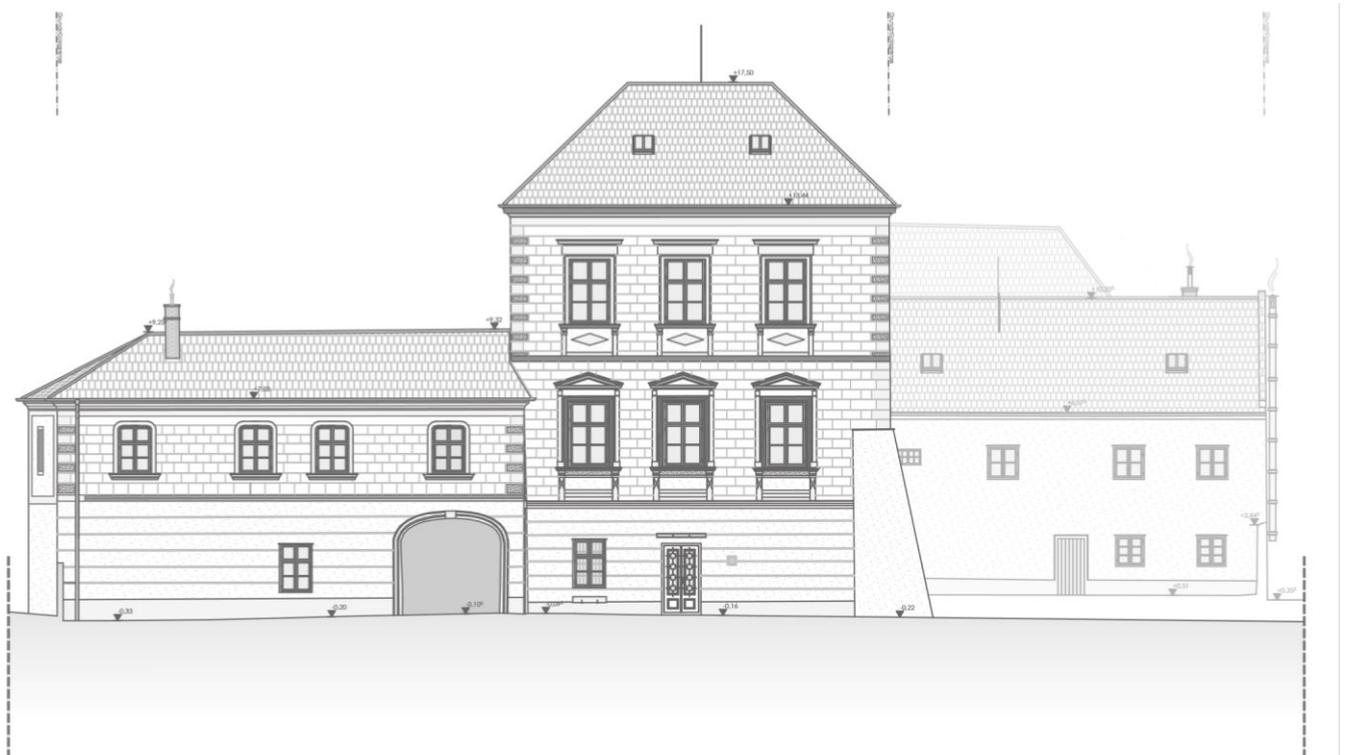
Bestandsplan Ansicht Nord M 1:250
